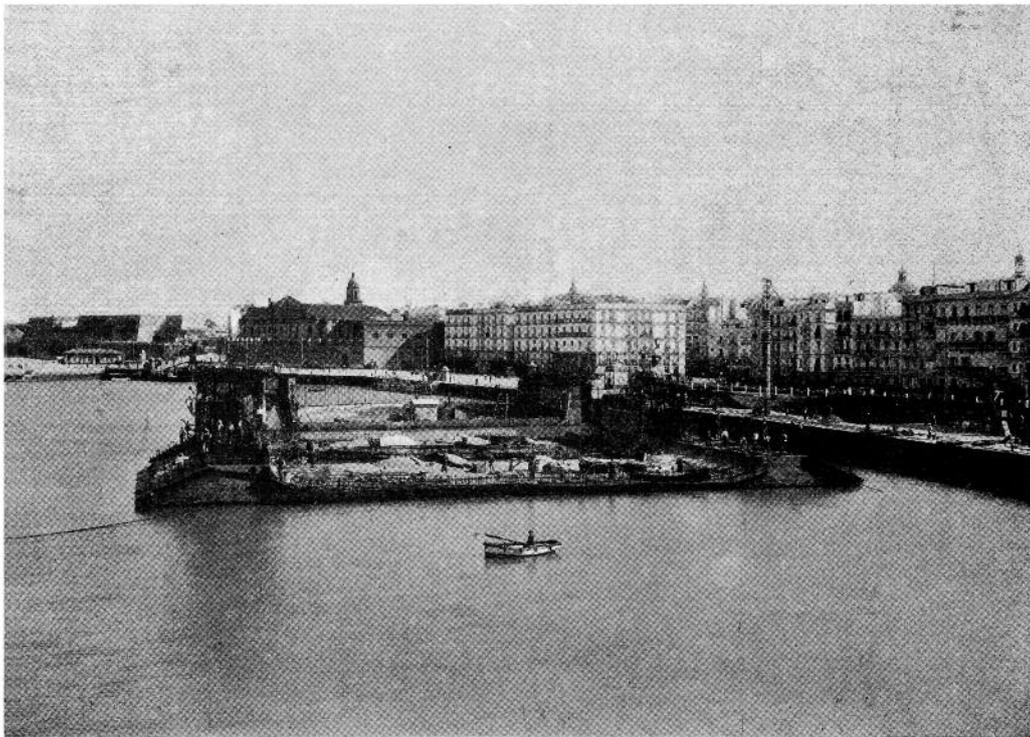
<sup>a</sup> Otra vista de los tres primeros cajones antes de su soldadura
